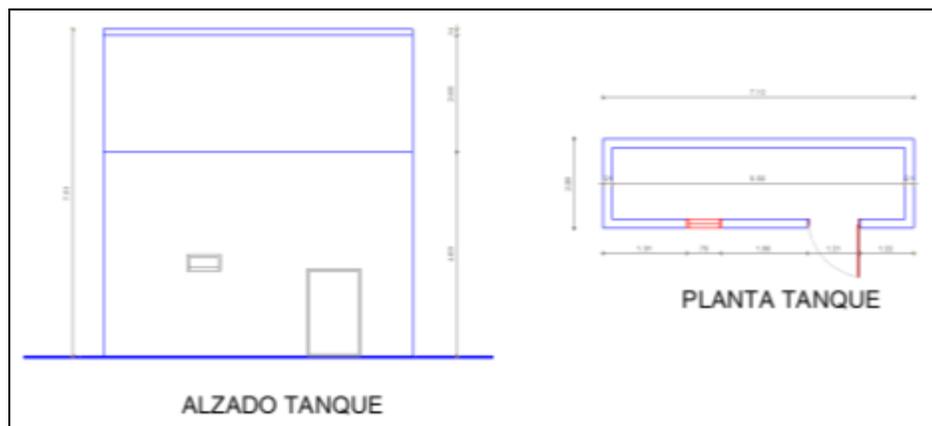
Estructura 9. Alzado y vista en planta del tanque.
